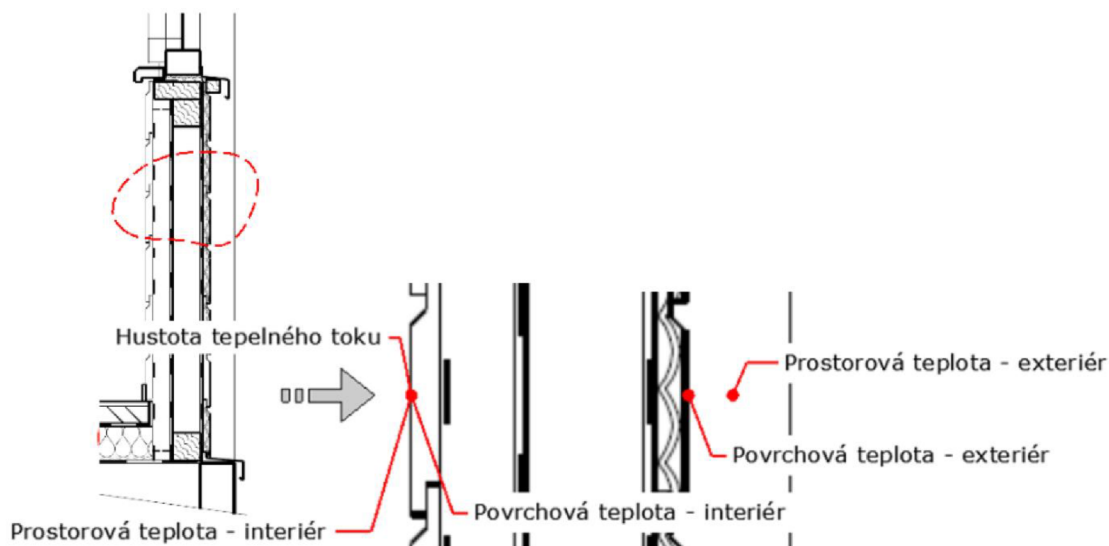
Řez měřené konstrukce, včetně konstrukčního uspořádání [autor]
